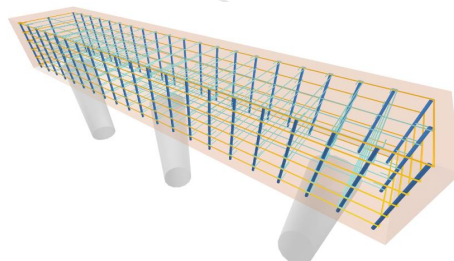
Modelo 3D do detalhamento de armaduras da fundação.
